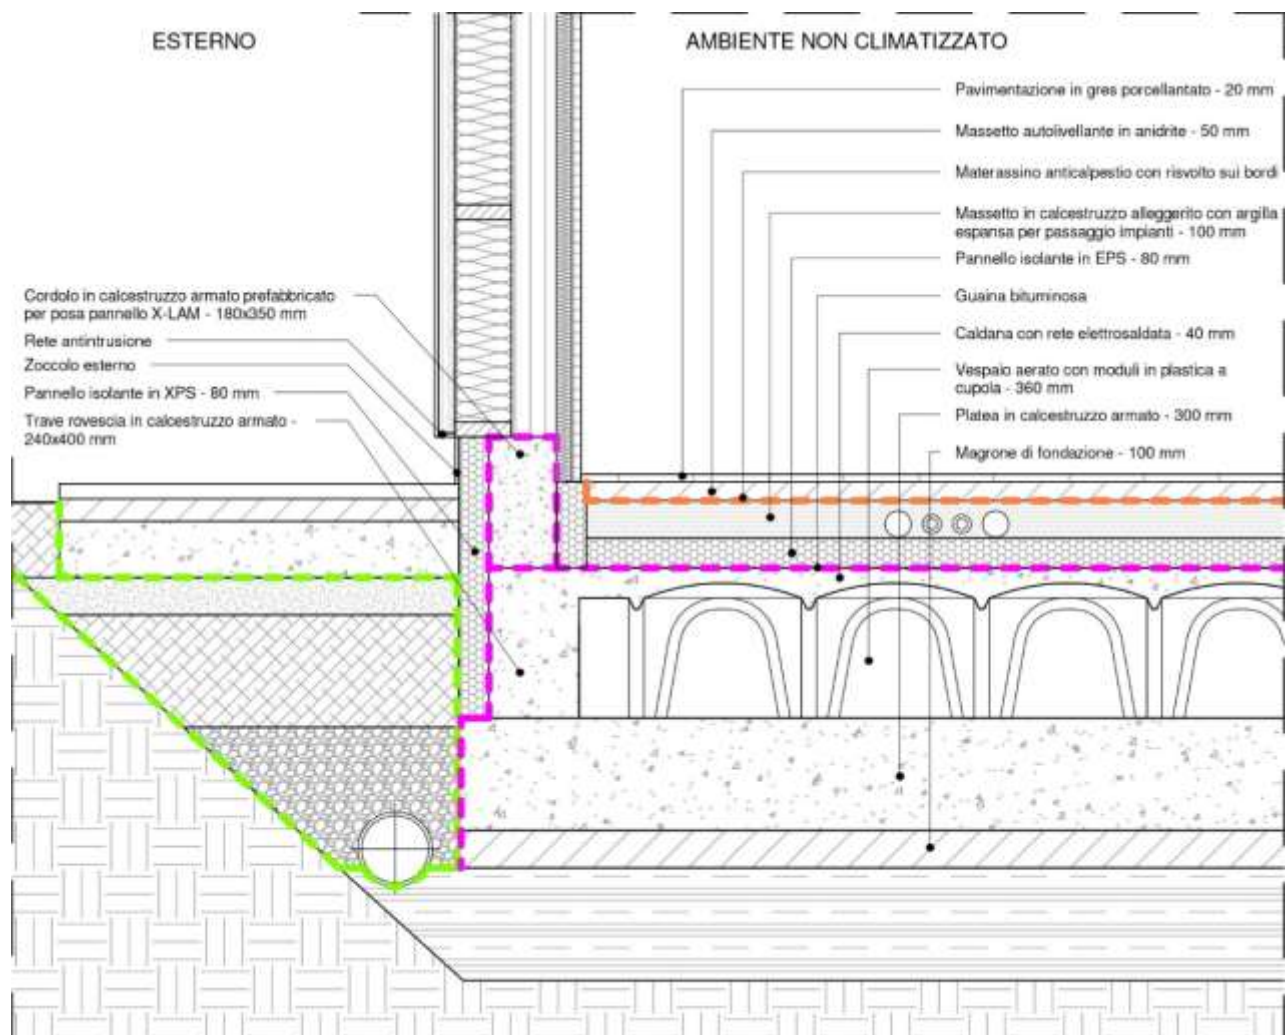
Dettaglio costruttivo nodo parete ventilata esterna e solaio piano terra - scala 1:20. [Fonte: elaborazione dell'autore]
